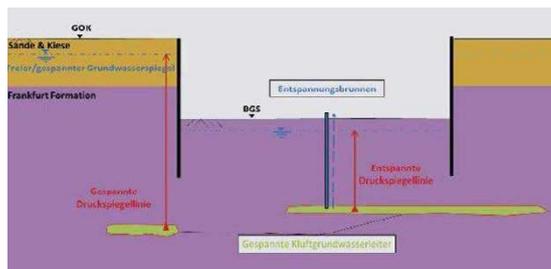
Darstellung einer Grundwasserentspannung innerhalb einer wasserundurchlässigen Baugrubenumschließung
